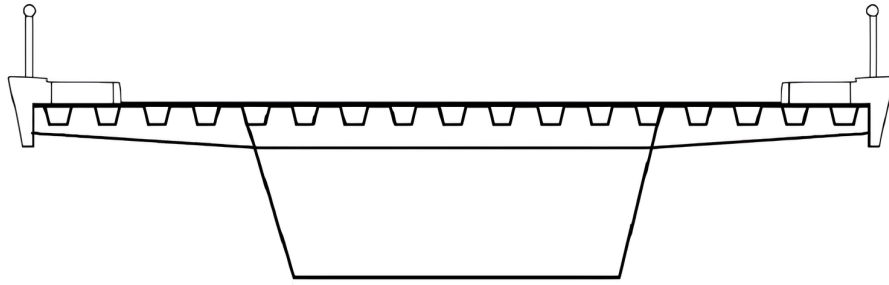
Dalle orthotrope d'un caisson métallique [5].
